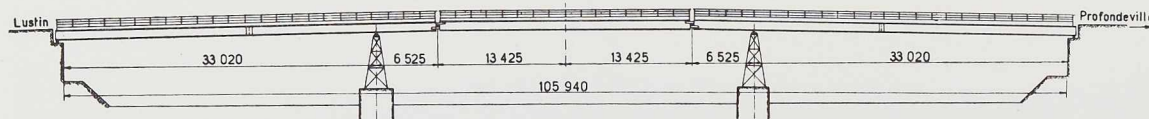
Elévation du pont-route de Lustin. Les maîtresses poutres (en poutrelles H) s'appuient sur les piles et les culées par l'intermédiaire de pièces d'appui en acier forgé et moulé. Les piles en rivières sont constituées par des chevalets métalliques en treillis.
